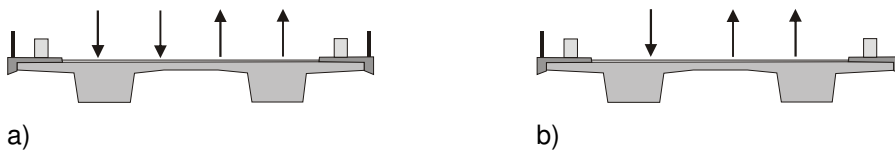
Beispiele für Brücken mit einteiligem Querschnitt (gemeinsamer Überbau für beide Richtungsfahrbahnen)
